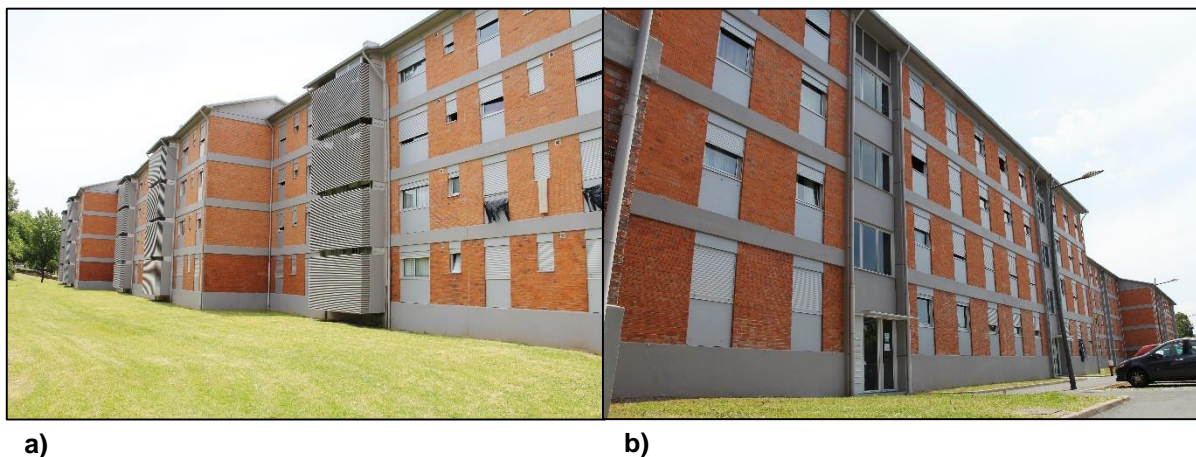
Fachadas do edifício. a) Fachada orientada a Nordeste; b) Fachada orientada a Sudoeste.
